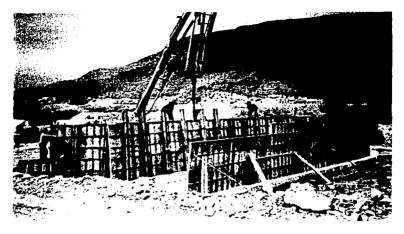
Construcción de muro de cabeza para tubo doble de concreto.
